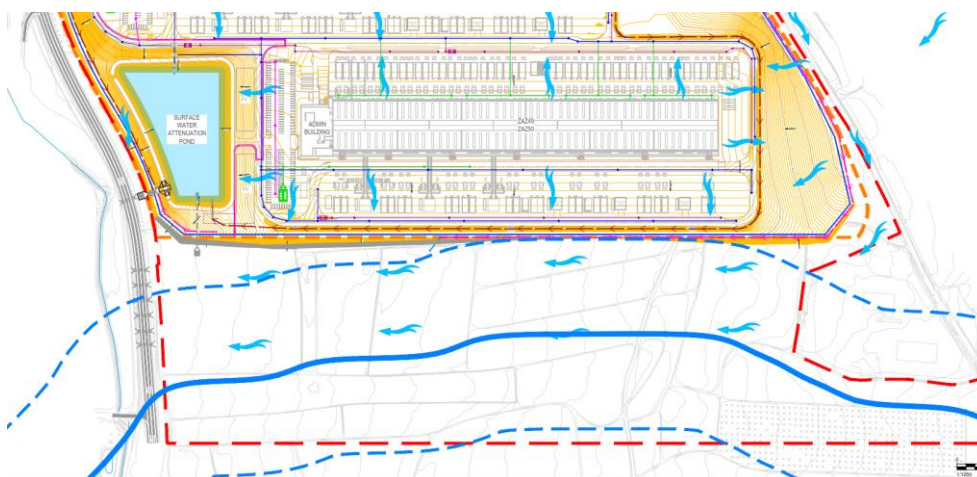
Carretera del proyecto exterior, drenaje y DPH
